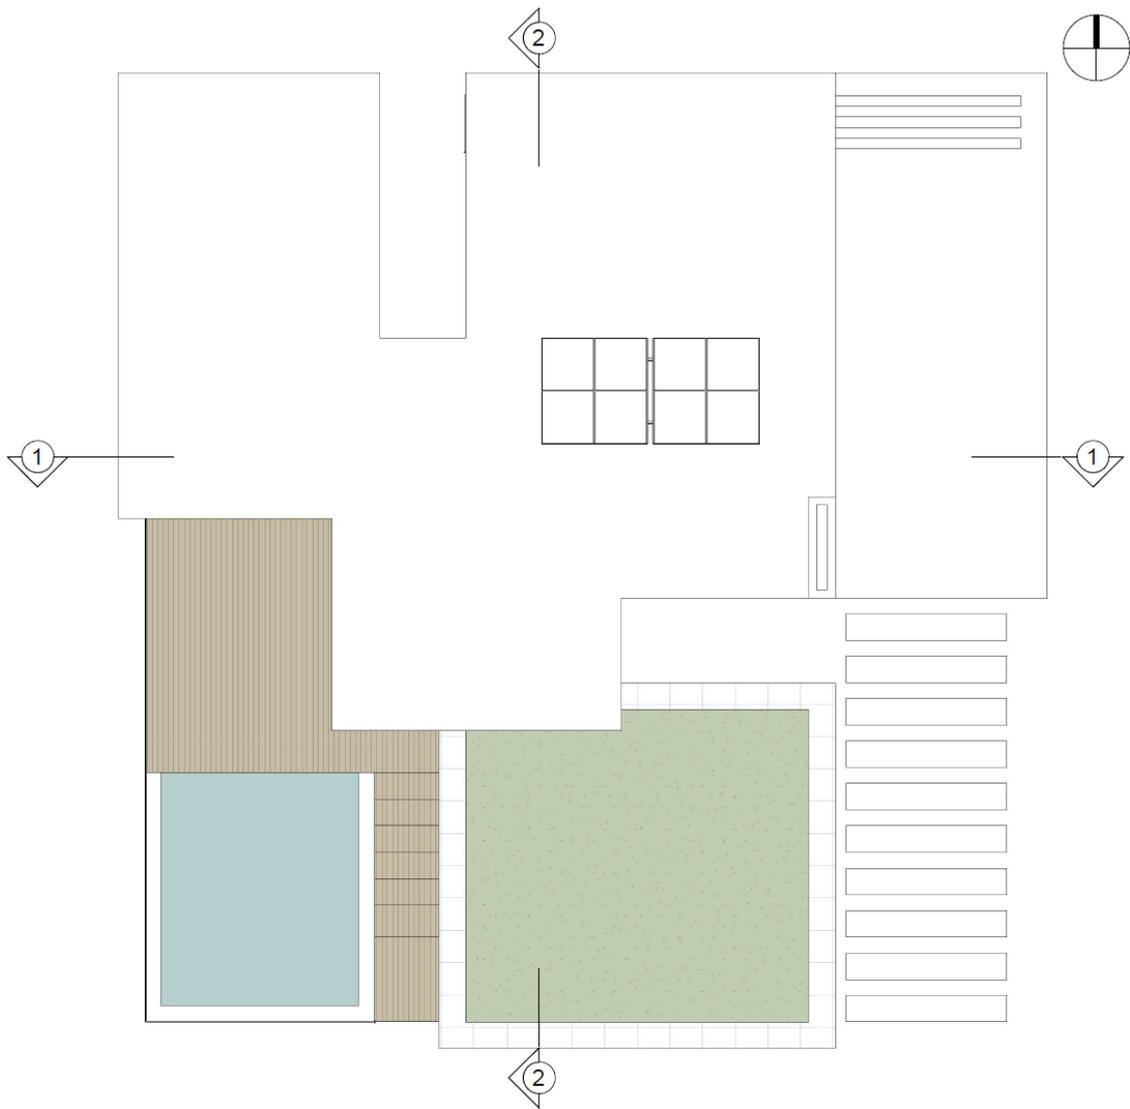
Planta cubierta. Fuente: Elaboración propia.
